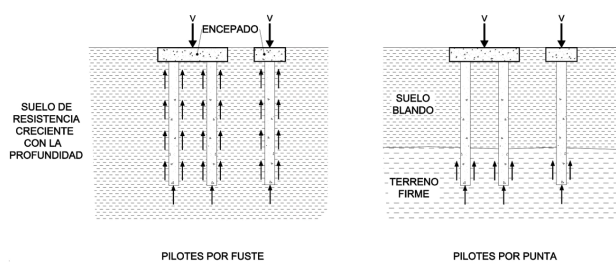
Esquema de cimentaciones profundas (pilotes).
